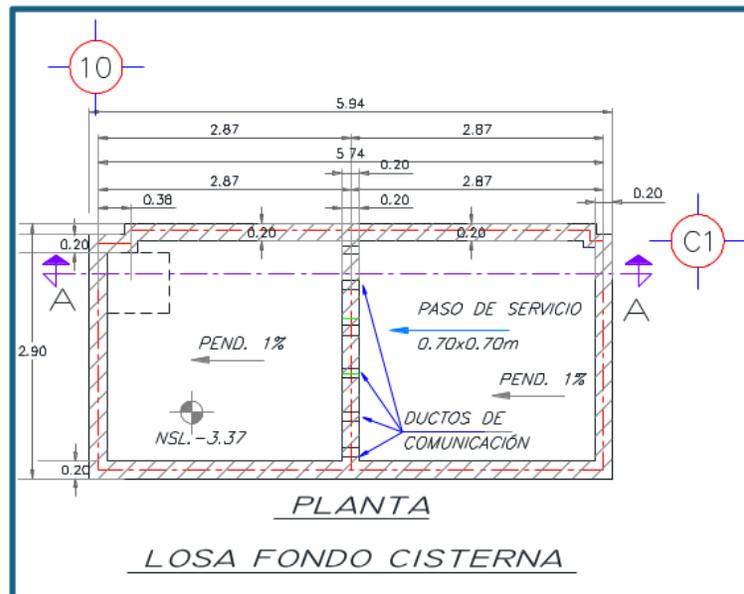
Planta de losa fondo de cisterna hidráulica
